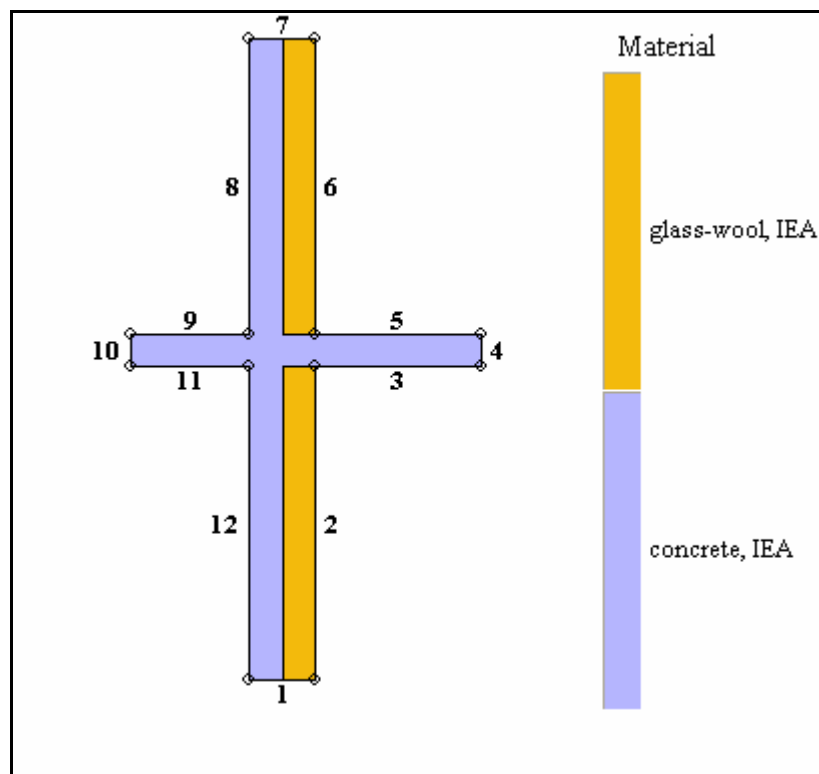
Wärmegeämmte Wand, die durch eine Betondecke unterbrochen ist.
